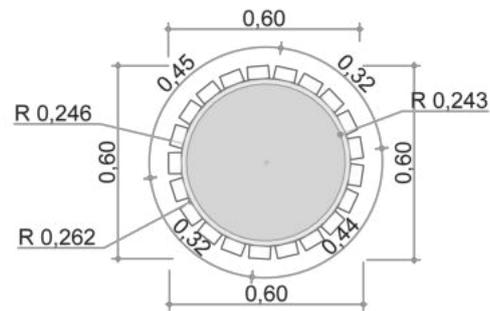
Planos 11 – Planta arquitectónica tipo 2. Fuente: Elaboración propia Nota: Planta arquitectónica detallada con sus respectivas medidas
